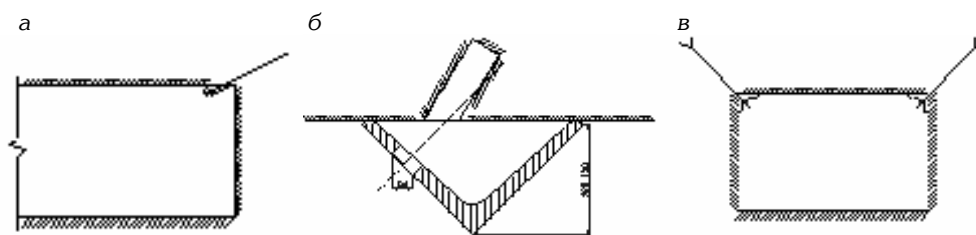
Угловой подхват с отверстием: а – крепление груди забоя; б – вида а; б – крепление боков выработки
